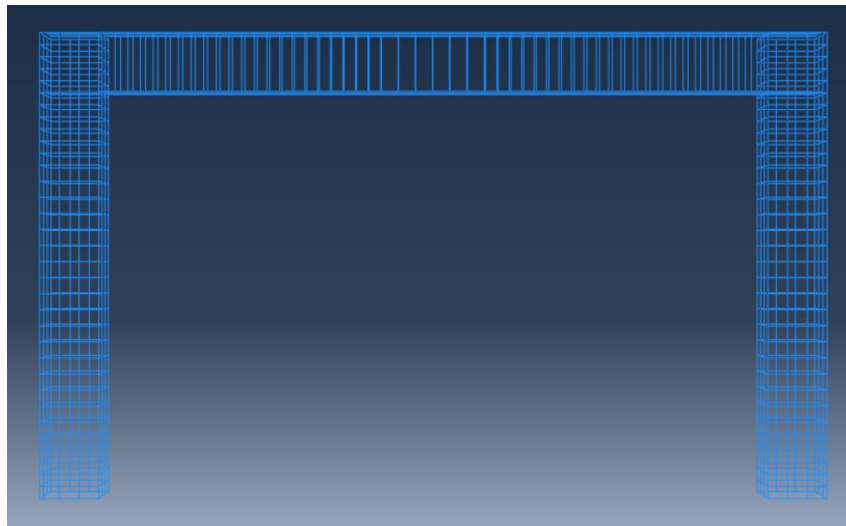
Armado del pórtico con los elementos de Viga y Columna.
